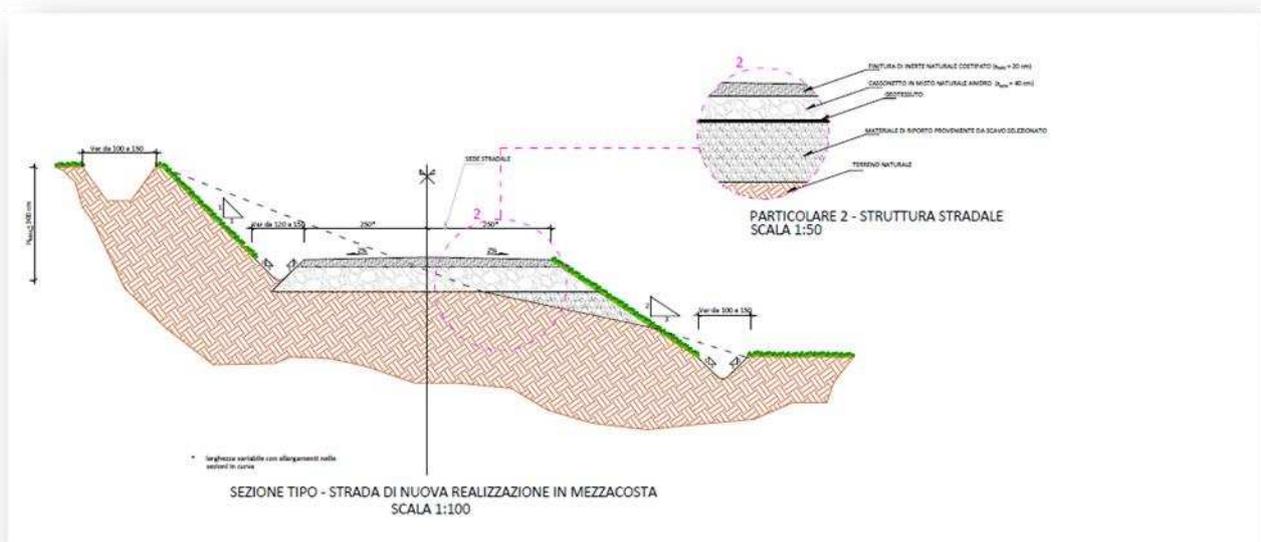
Estratto elaborato EDP0055 (Sezione stradali tipo e viabilità)
